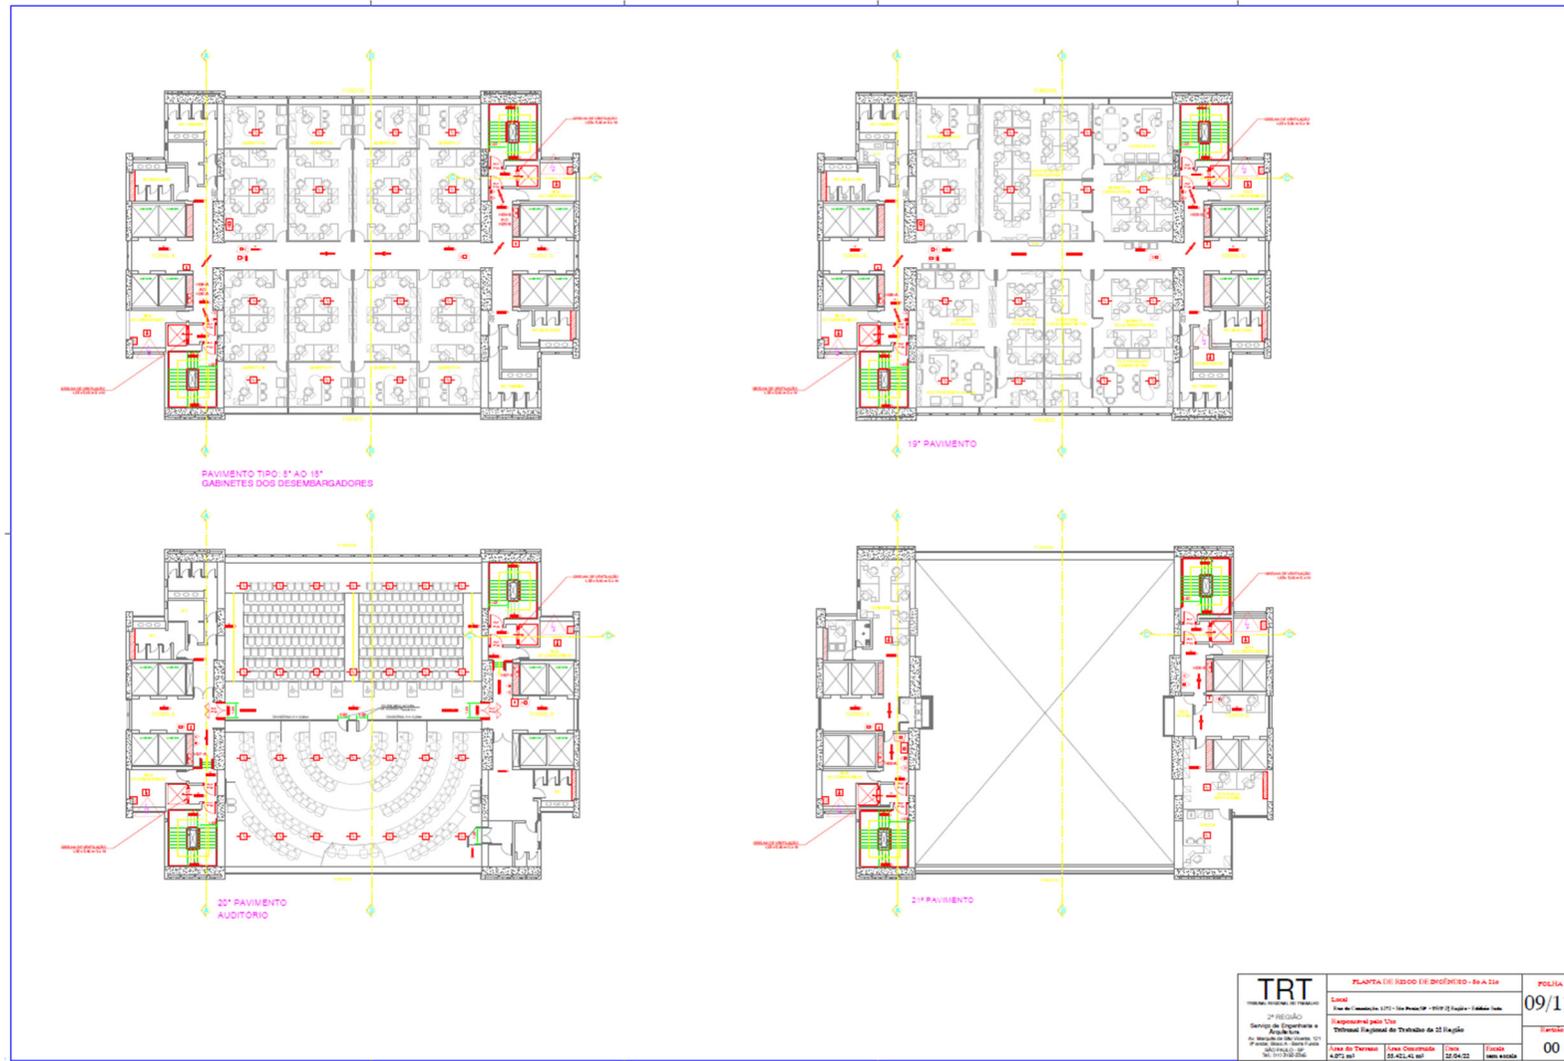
Planta de Risco de Incêndio - 8º ao 21º
